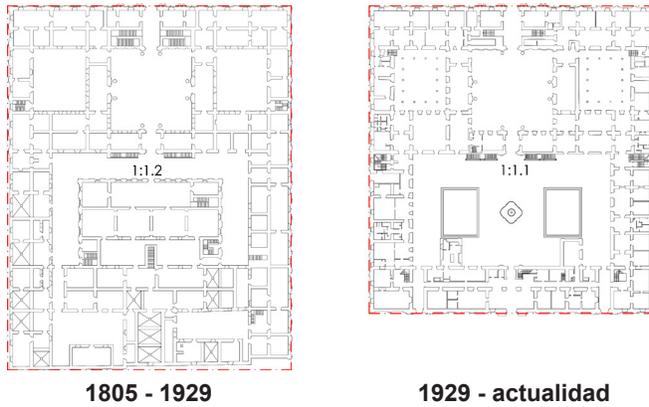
Regularidad en planta Palacio de la Moneda. Elaboración propia
